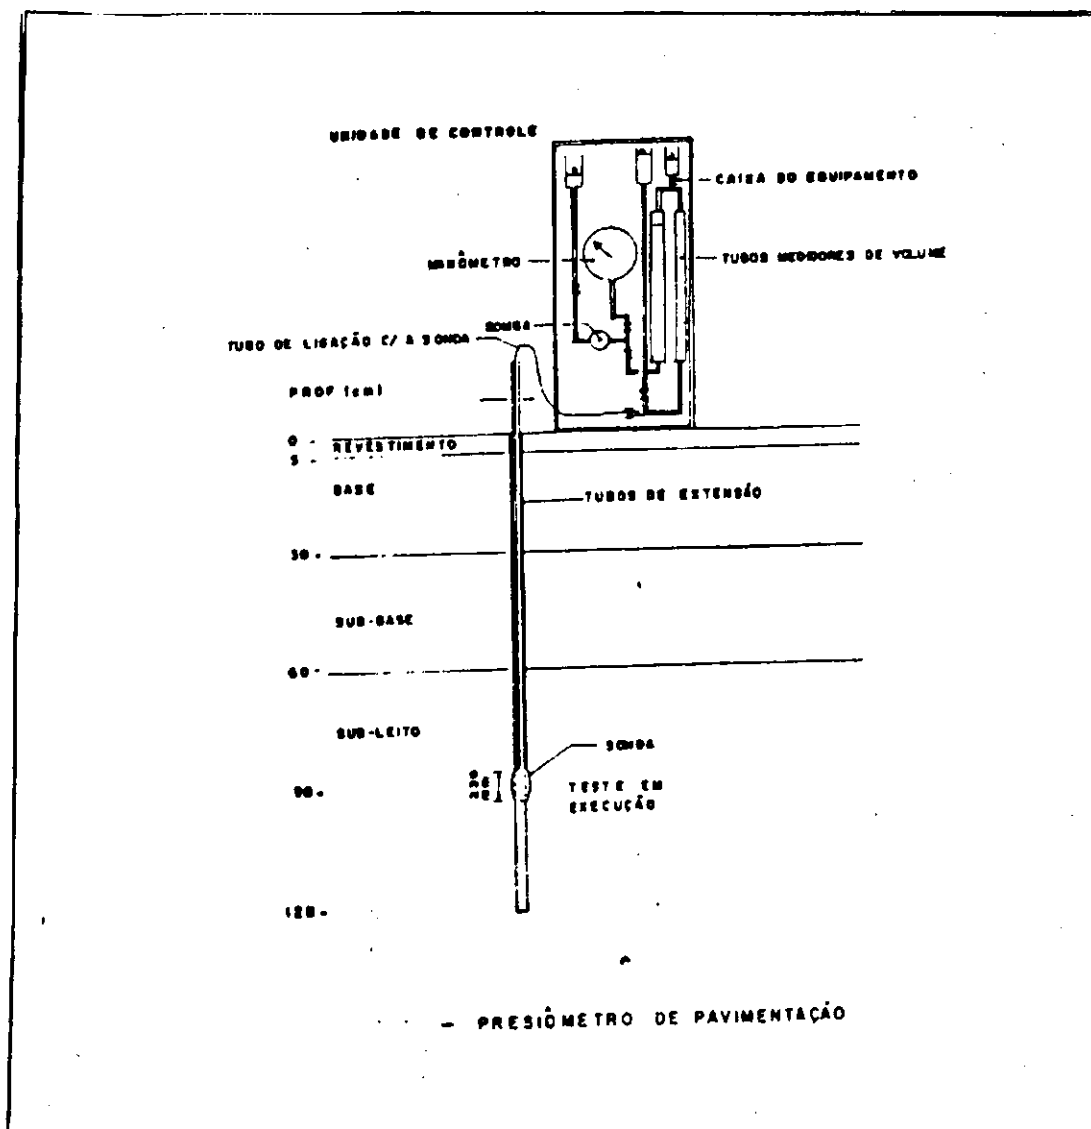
Esquema geral do pressiômetro de pavimentação (LUCENA & BEZERRA, 1988).
